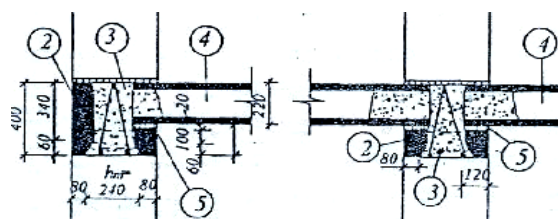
Конструкция *СбМт* АС поясов (ригелей каркасно-каменных зданий) предусмотренных в НСМ F.03.02-2005 [11, с. 21]: 1 - стена; 2 - сборный пояс; 3 - монолитный бетон; 4 - перекрытие; 5 - растворный шов.
